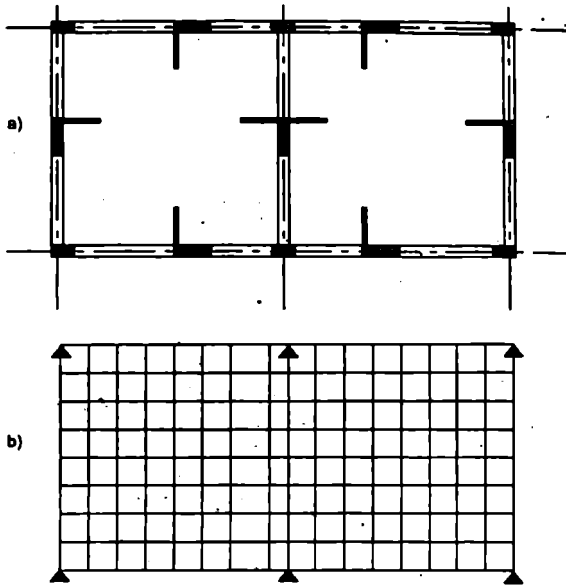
a) Planta de fôrmas de um pavimento com lajes e vigas. b) Grelha equivalente representando o pavimento.
